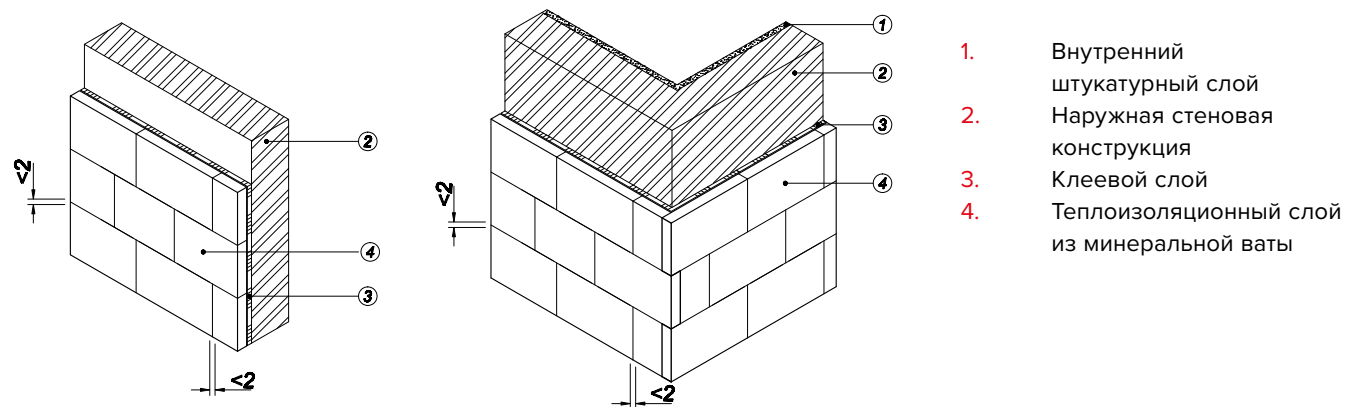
Перевязка стыков плит теплоизоляции на внутренних и наружных углах здания
